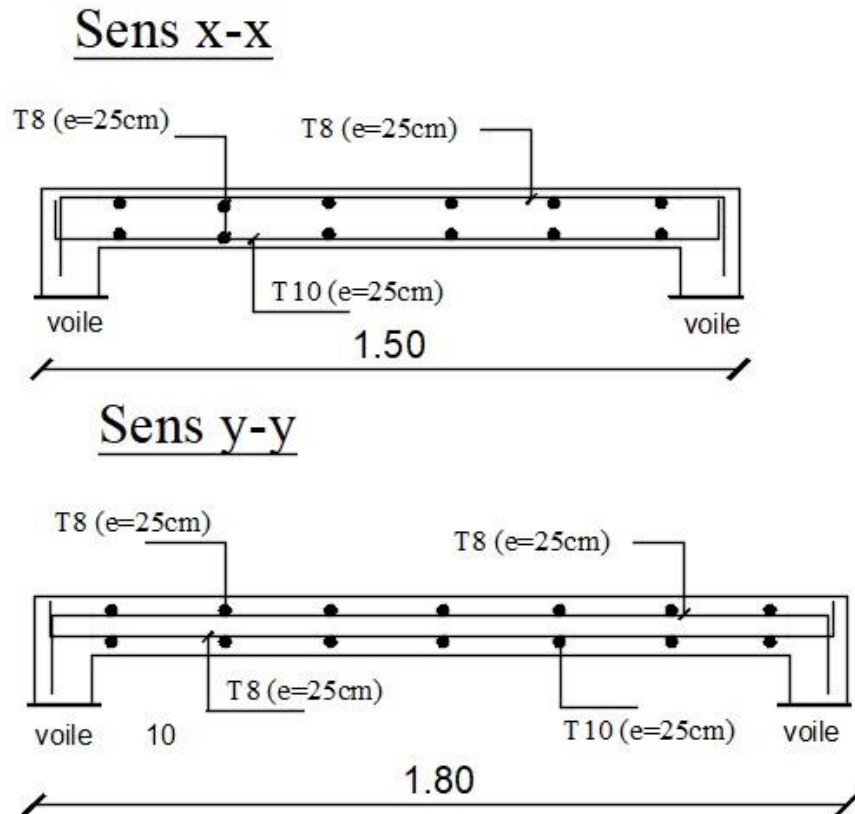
Schéma de ferrailage de la dalle salle machine
